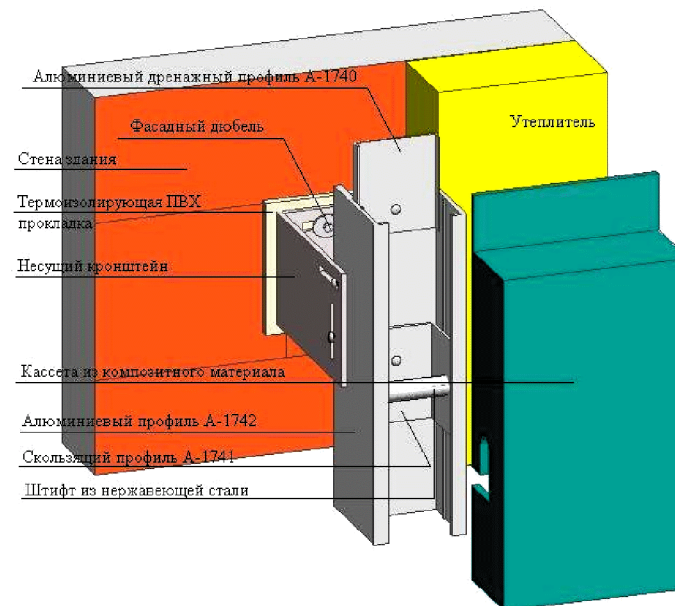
Схема навесного вентилируемого фасада с использованием кассет из композитного материала
